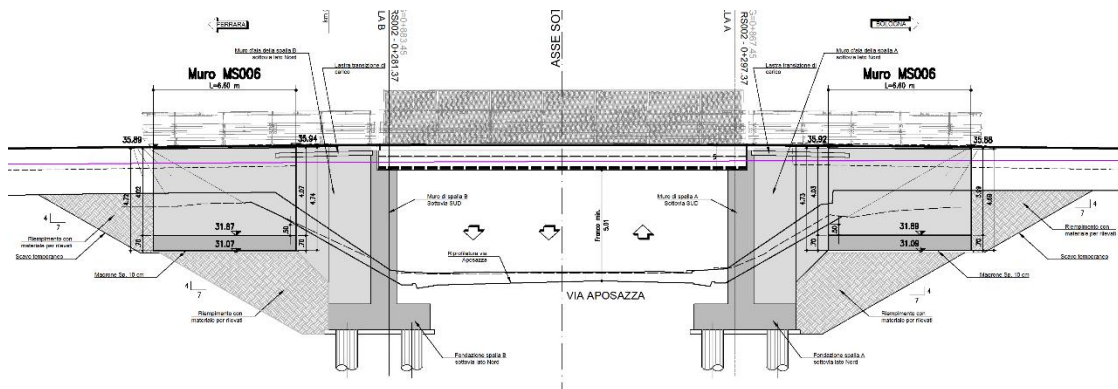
MS006 - Prospetto dei muri a S e N di via Aposazza
